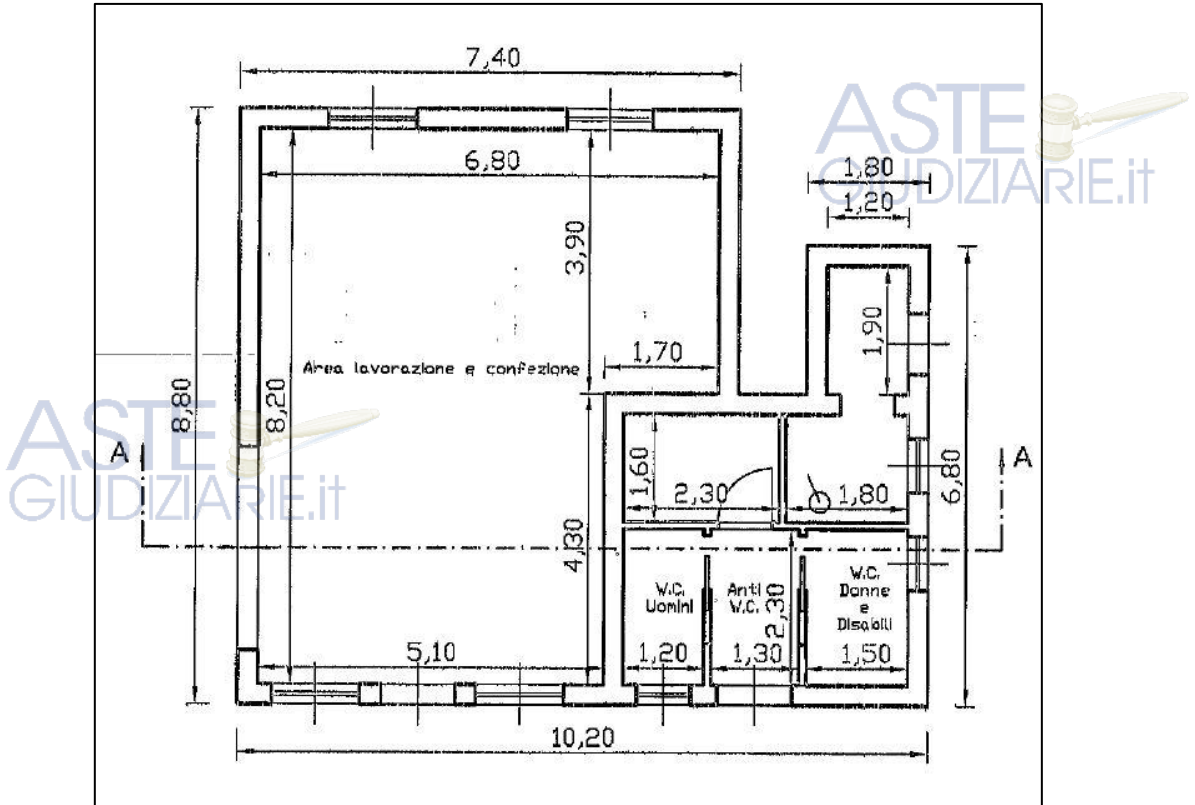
pianta immobile p.lla 298 - progetto autorizzato
